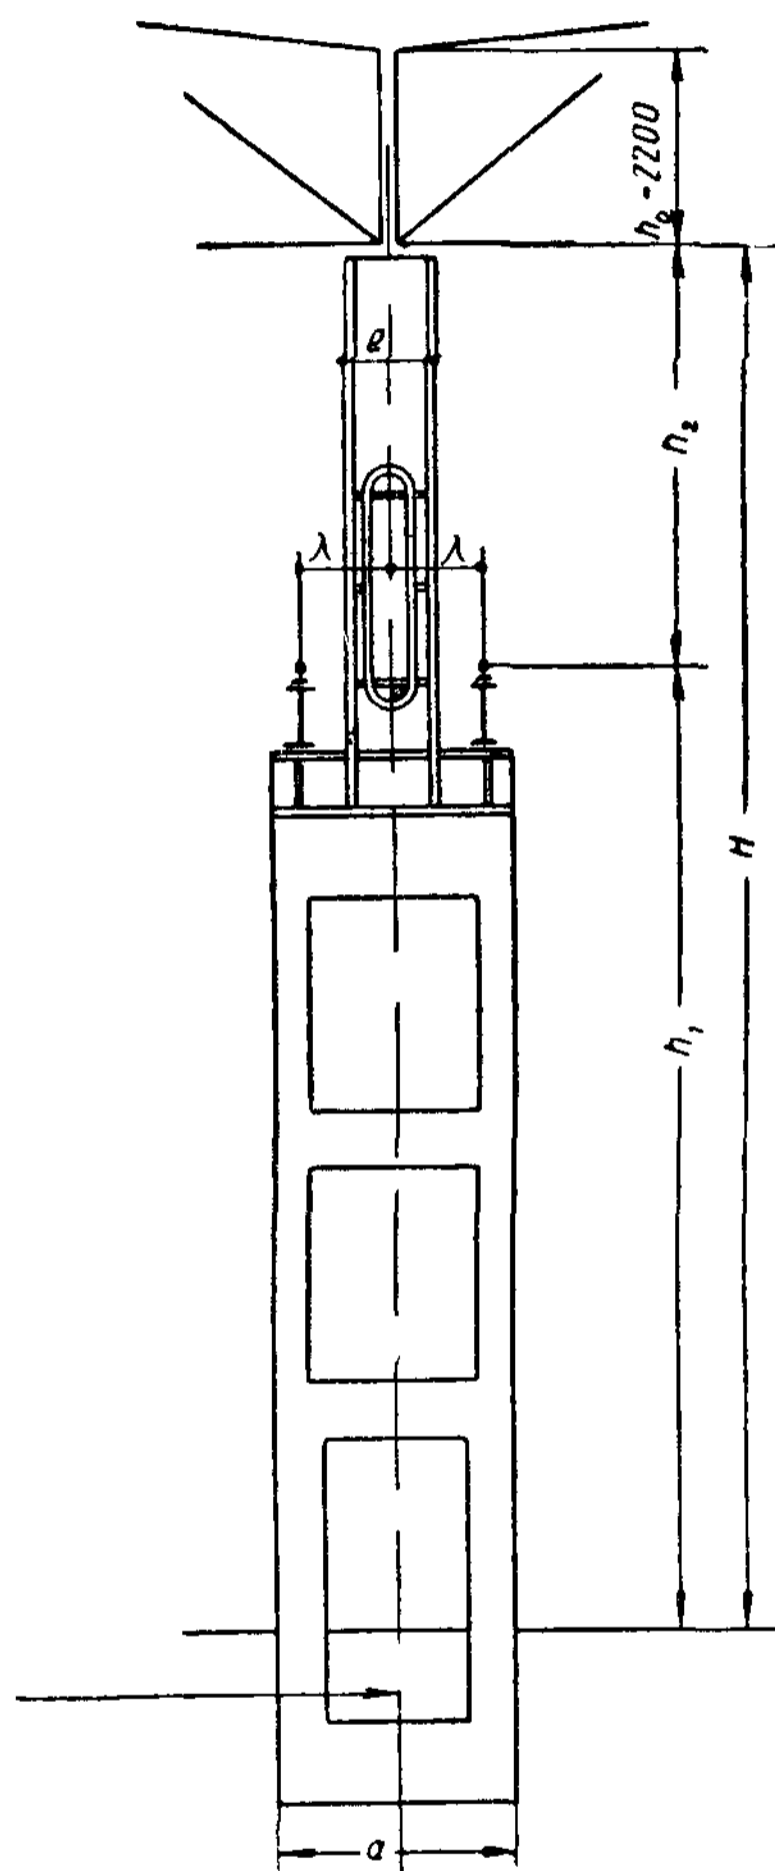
Комбинированная сталежелезобетонная колонна под тяжелую нагрузку
